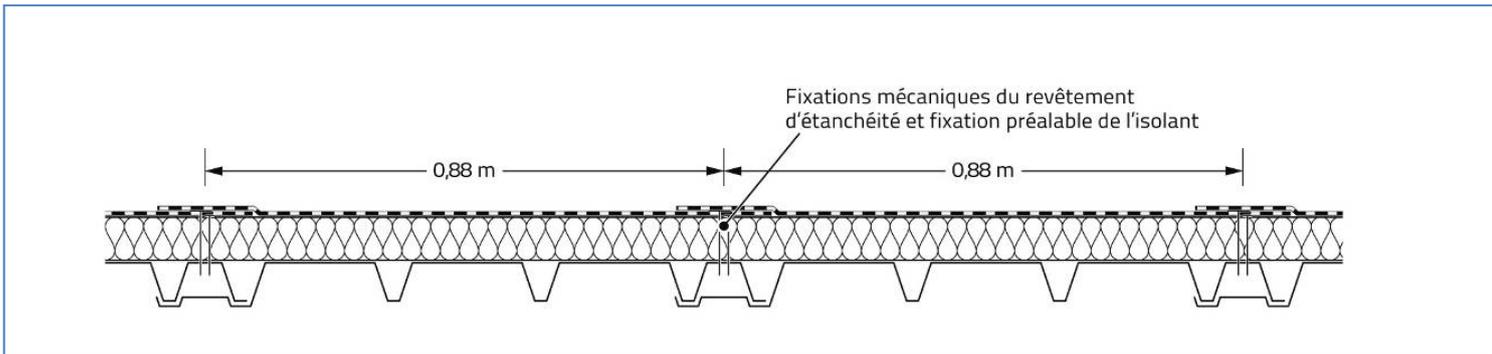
Fixations mécaniques de l'isolant et du revêtement d'étanchéité
